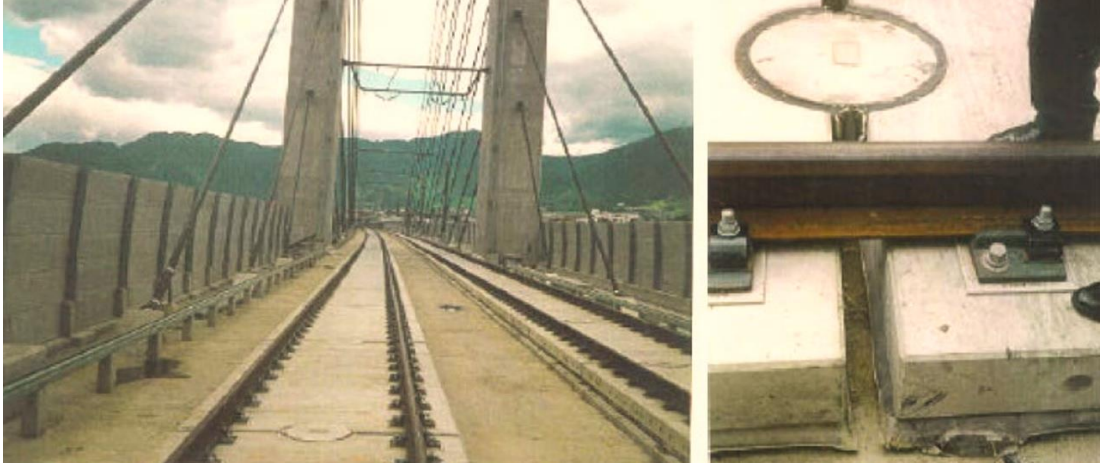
LVT sisteminde kullanılan travers blok yapısı
